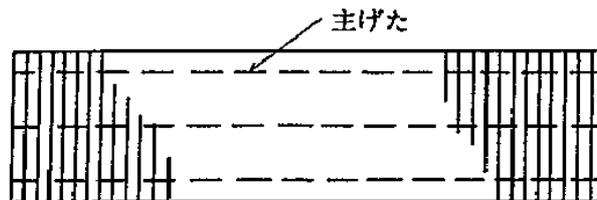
主鉄筋の配筋方向 (直橋の場合)
